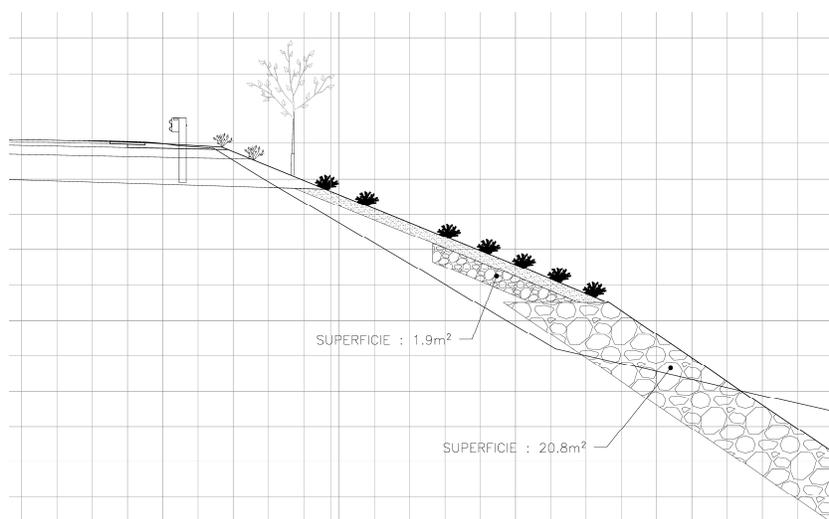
Revêtement de protection en pierres, stabilisation des talus du secteur sud
